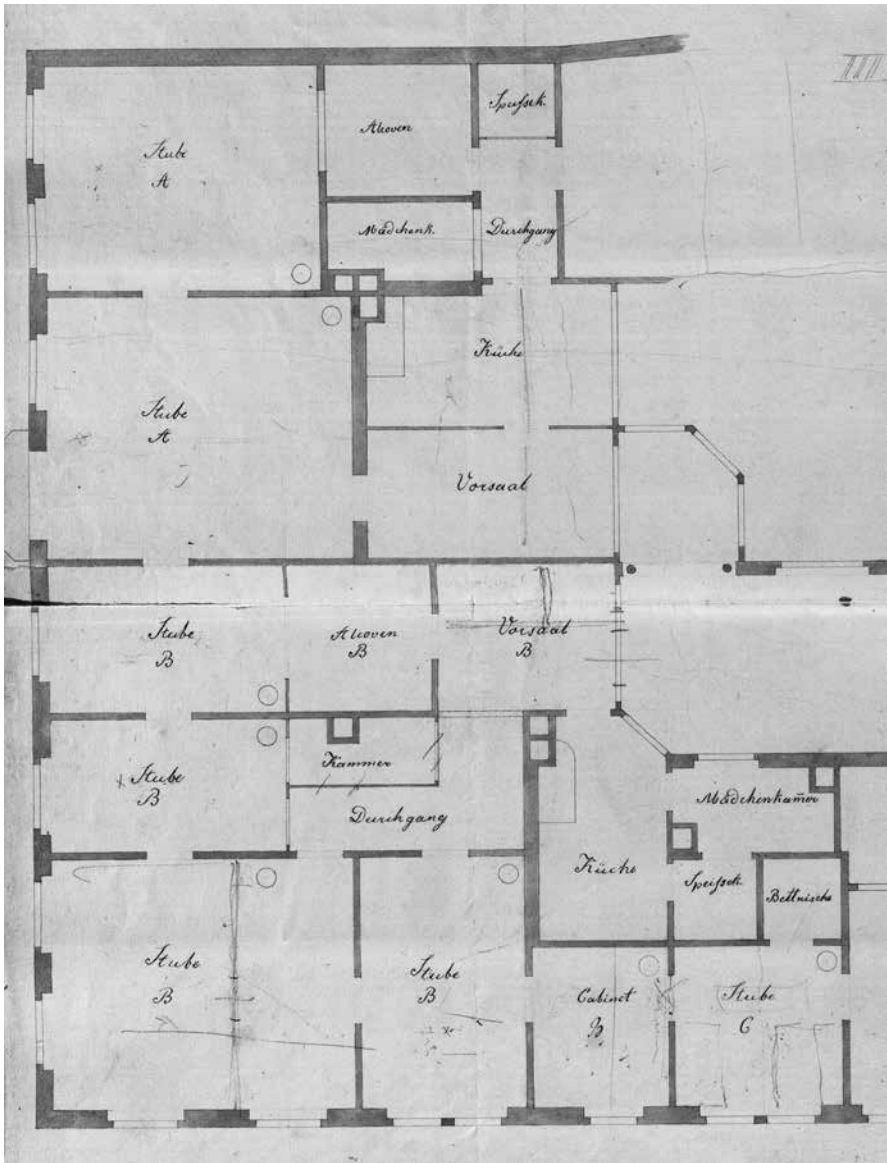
Grundriss der Wohnung Friedrich Wiecks in Leipzig, Reichsstraße Nr. 579 (1844); Leipzig, Stadtarchiv, Bauakten, Nr. 3711, fol. 35 (Ausschnitt).
